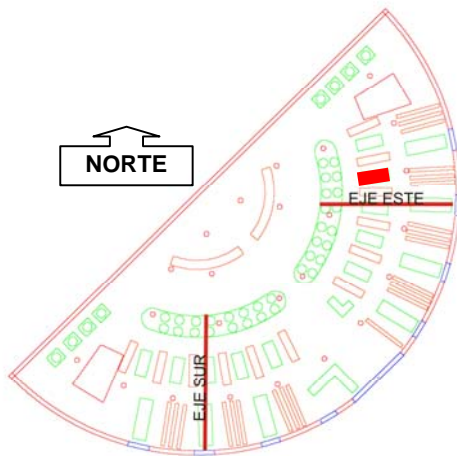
Distribución del equipamiento en la planta baja de la biblioteca. Puesto de medición en rojo.
